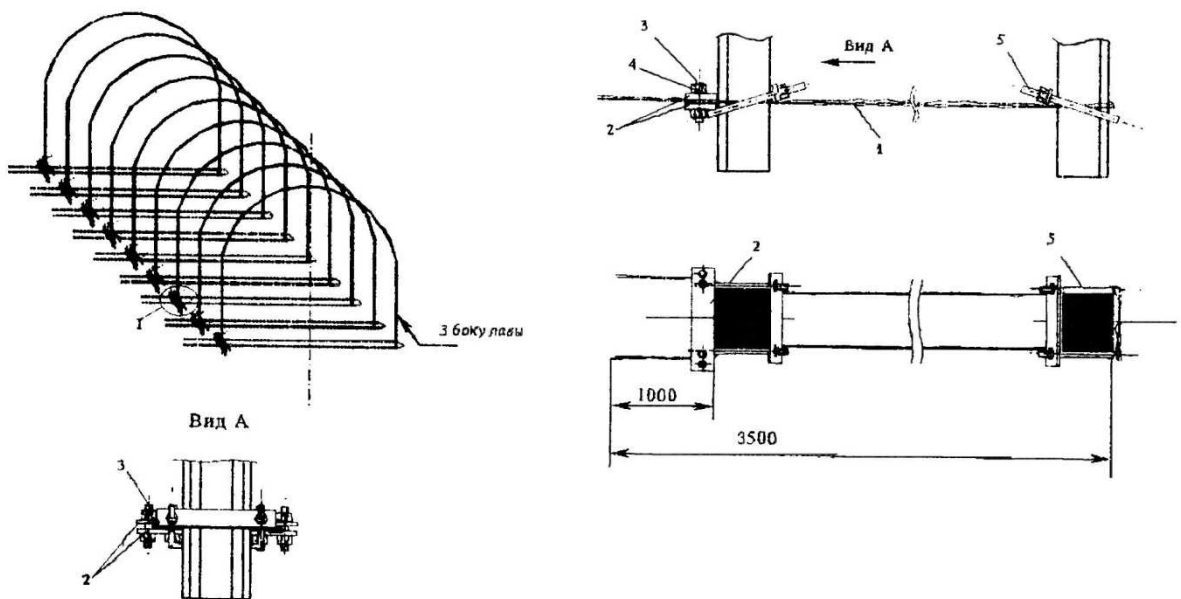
Схема установки гнучкого лежня із сполощного відрізка металевого канату: 1 – канат; 2 – планки; 3 – шпильки; 4 – гайки; 5 – хомути
